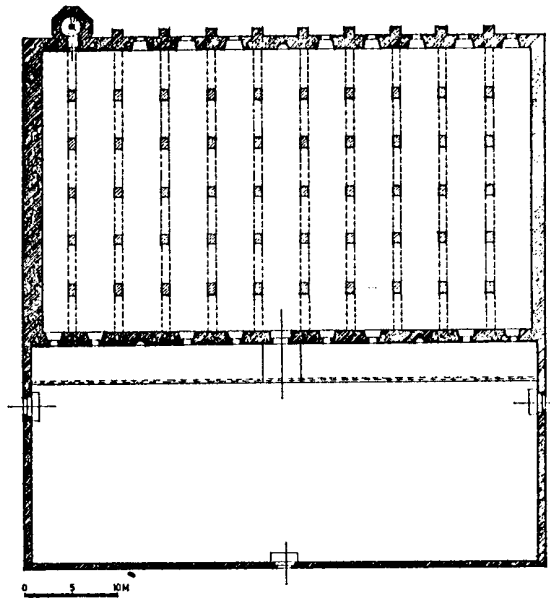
مسقط أفقي لجامع قرطبة (عن : Moreno)
